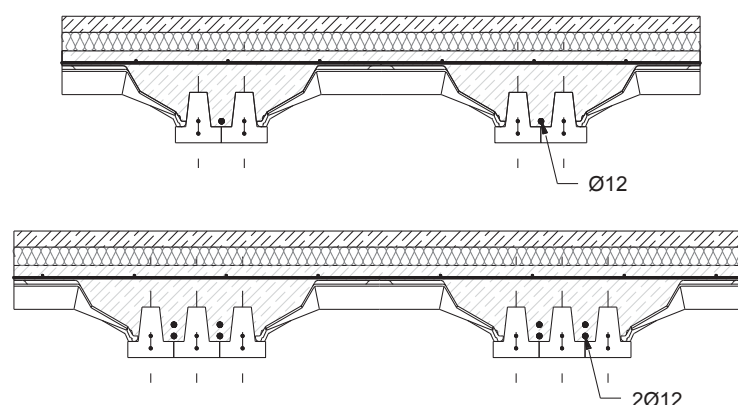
Поперечное сечение перекрытия RECTOLIGHT
